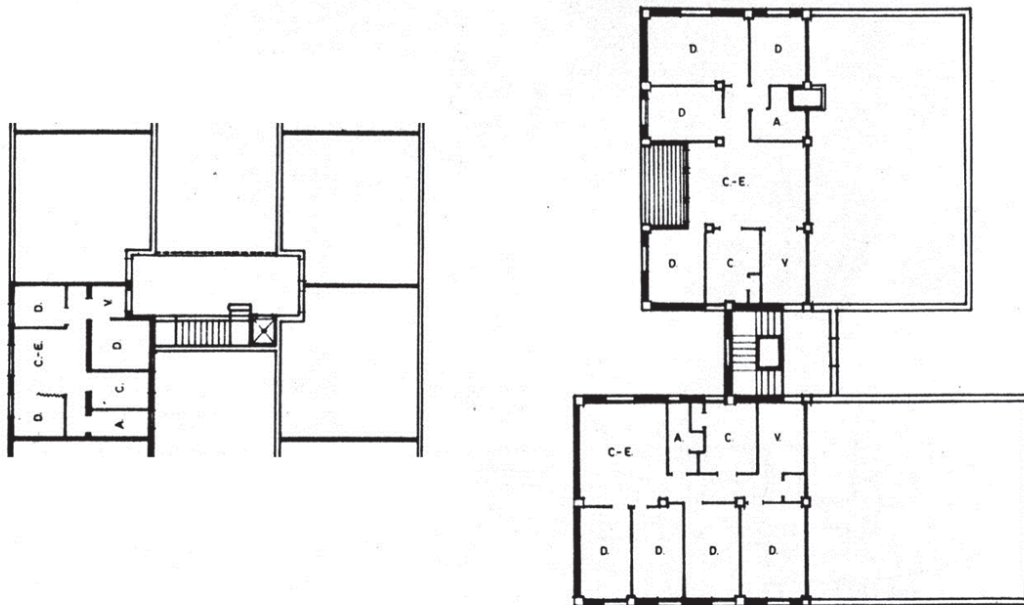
Grupo Virgen de los Desamparados. Planta de viviendas tipo de bloque *a redent* y bloque doble. (Escala 1/300).
